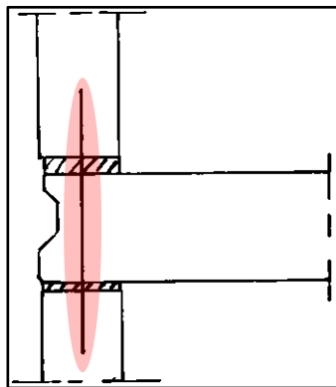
Detail horizontale interne trekbandwapening bouwmuur Bestcon 60.
